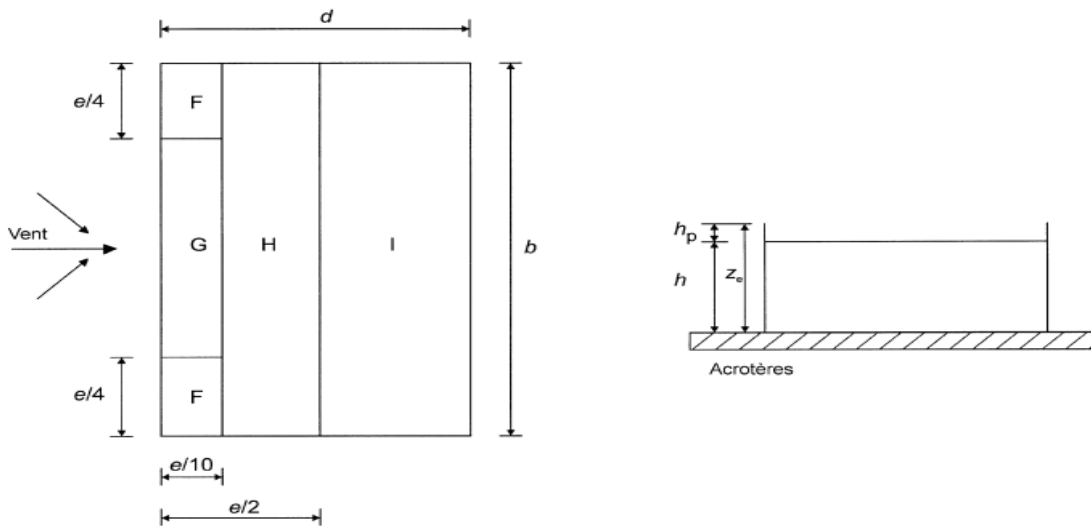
Vue en plan des zones de pression de la toiture plates.
